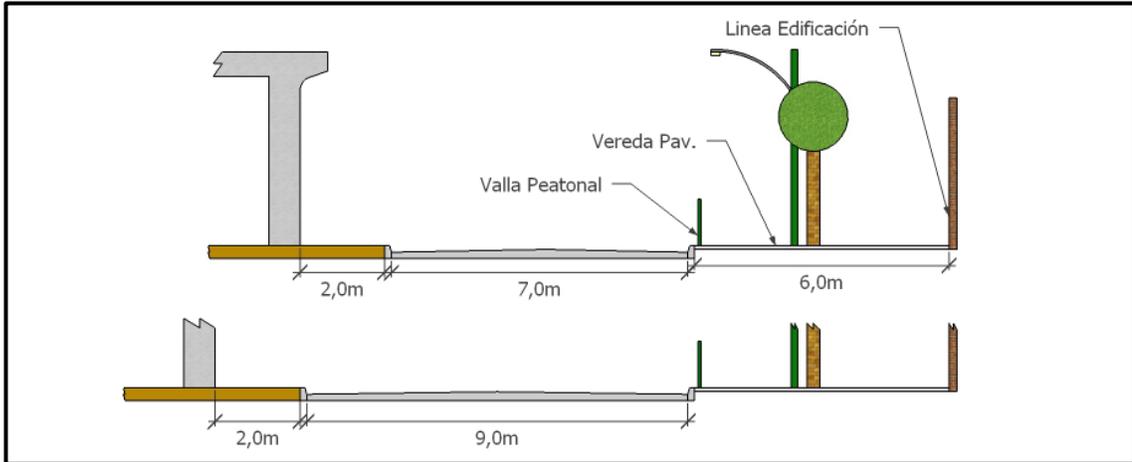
Perfil Transversal Eje B (Acceso VTP) – Ancho calzada mínimo y máximo
